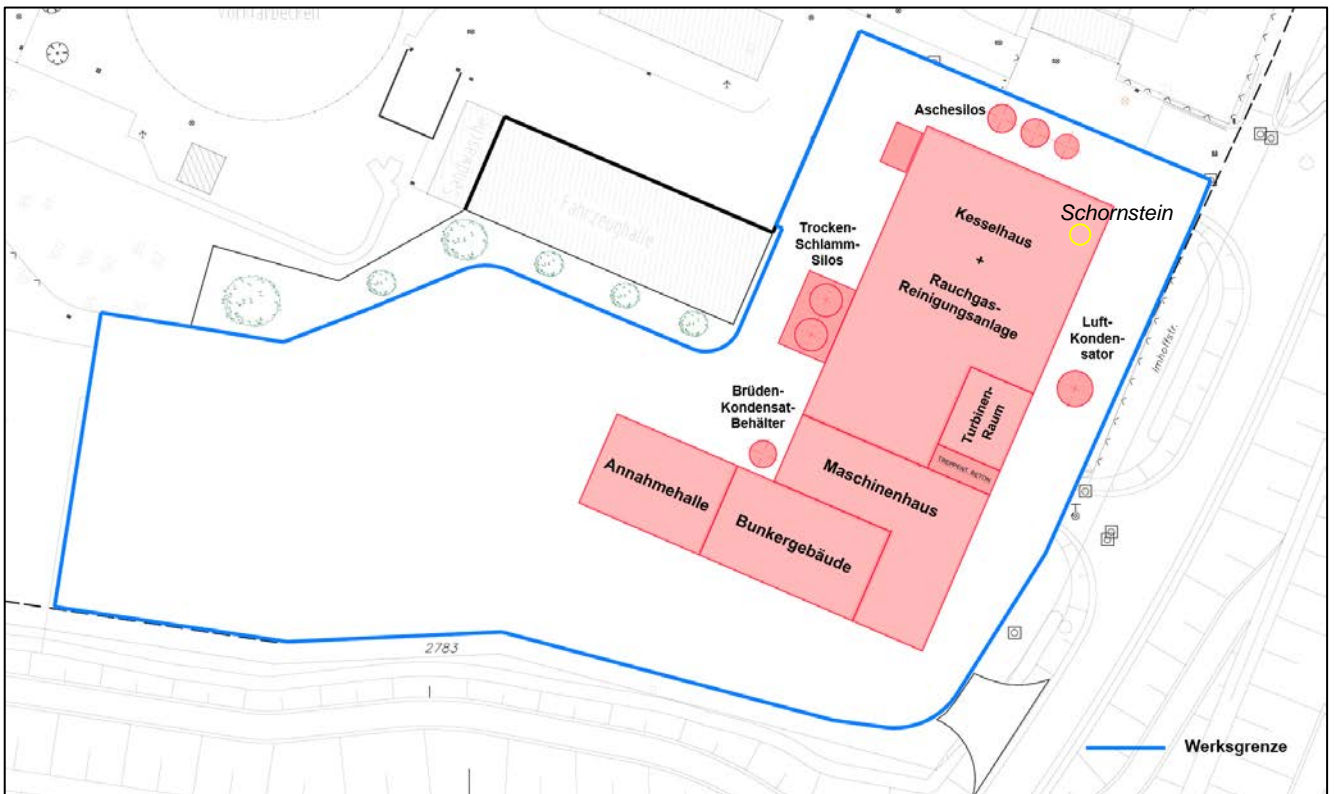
Lageplan des geplanten Gebäudes der Klärschlammverbrennungsanlage
